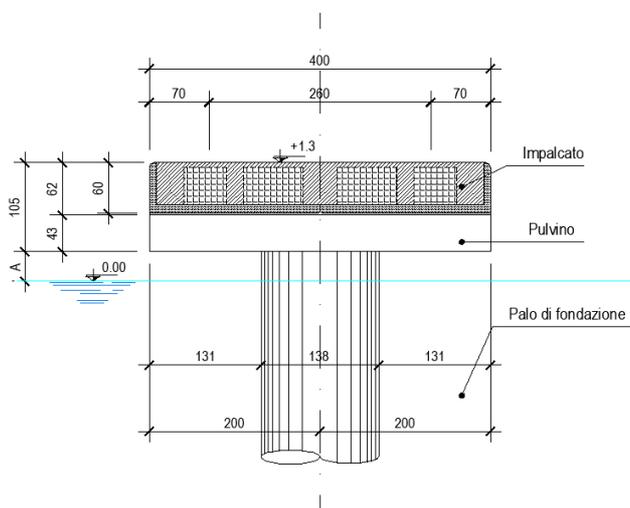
Sezione tipo pontili (impalcato di progetto)
